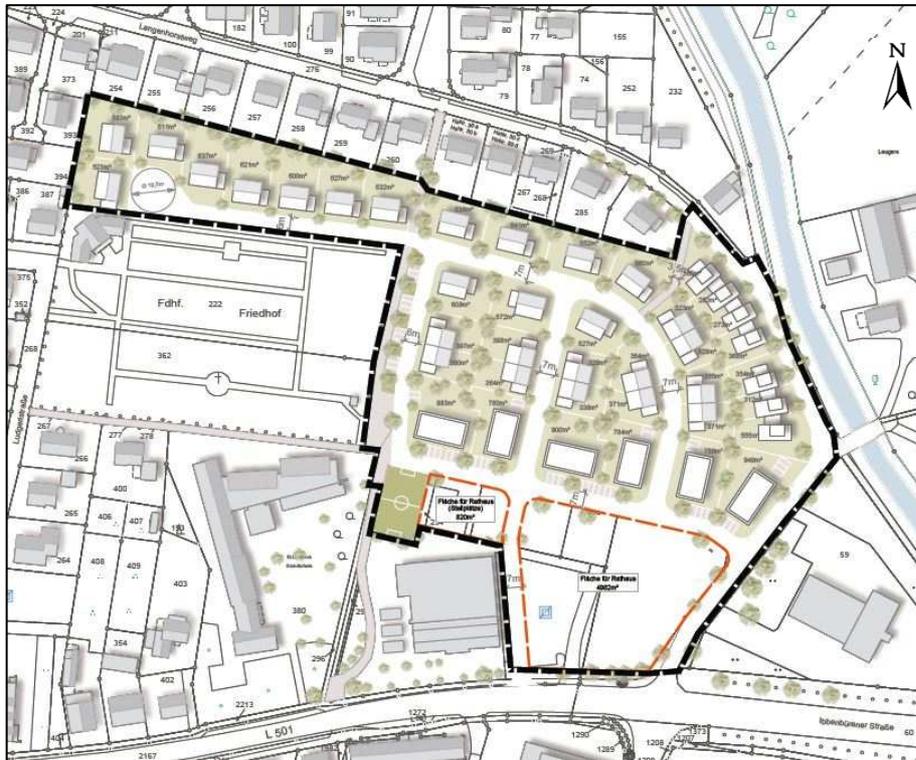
Lageplan mit Darstellung eines Bebauungskonzepts
